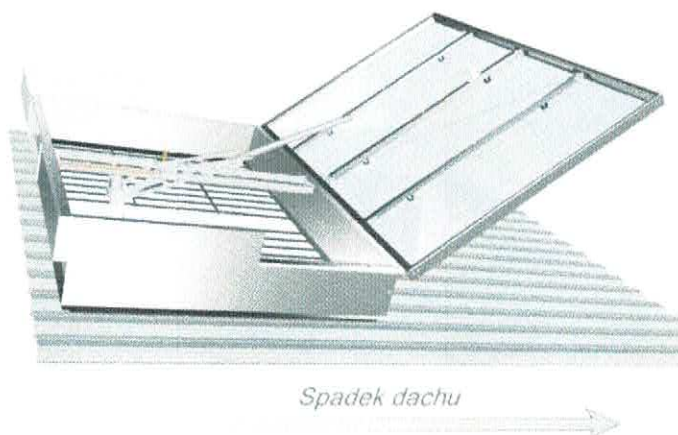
Wytyczne posadowienia kłapy SCD na konstrukcji dachu.
